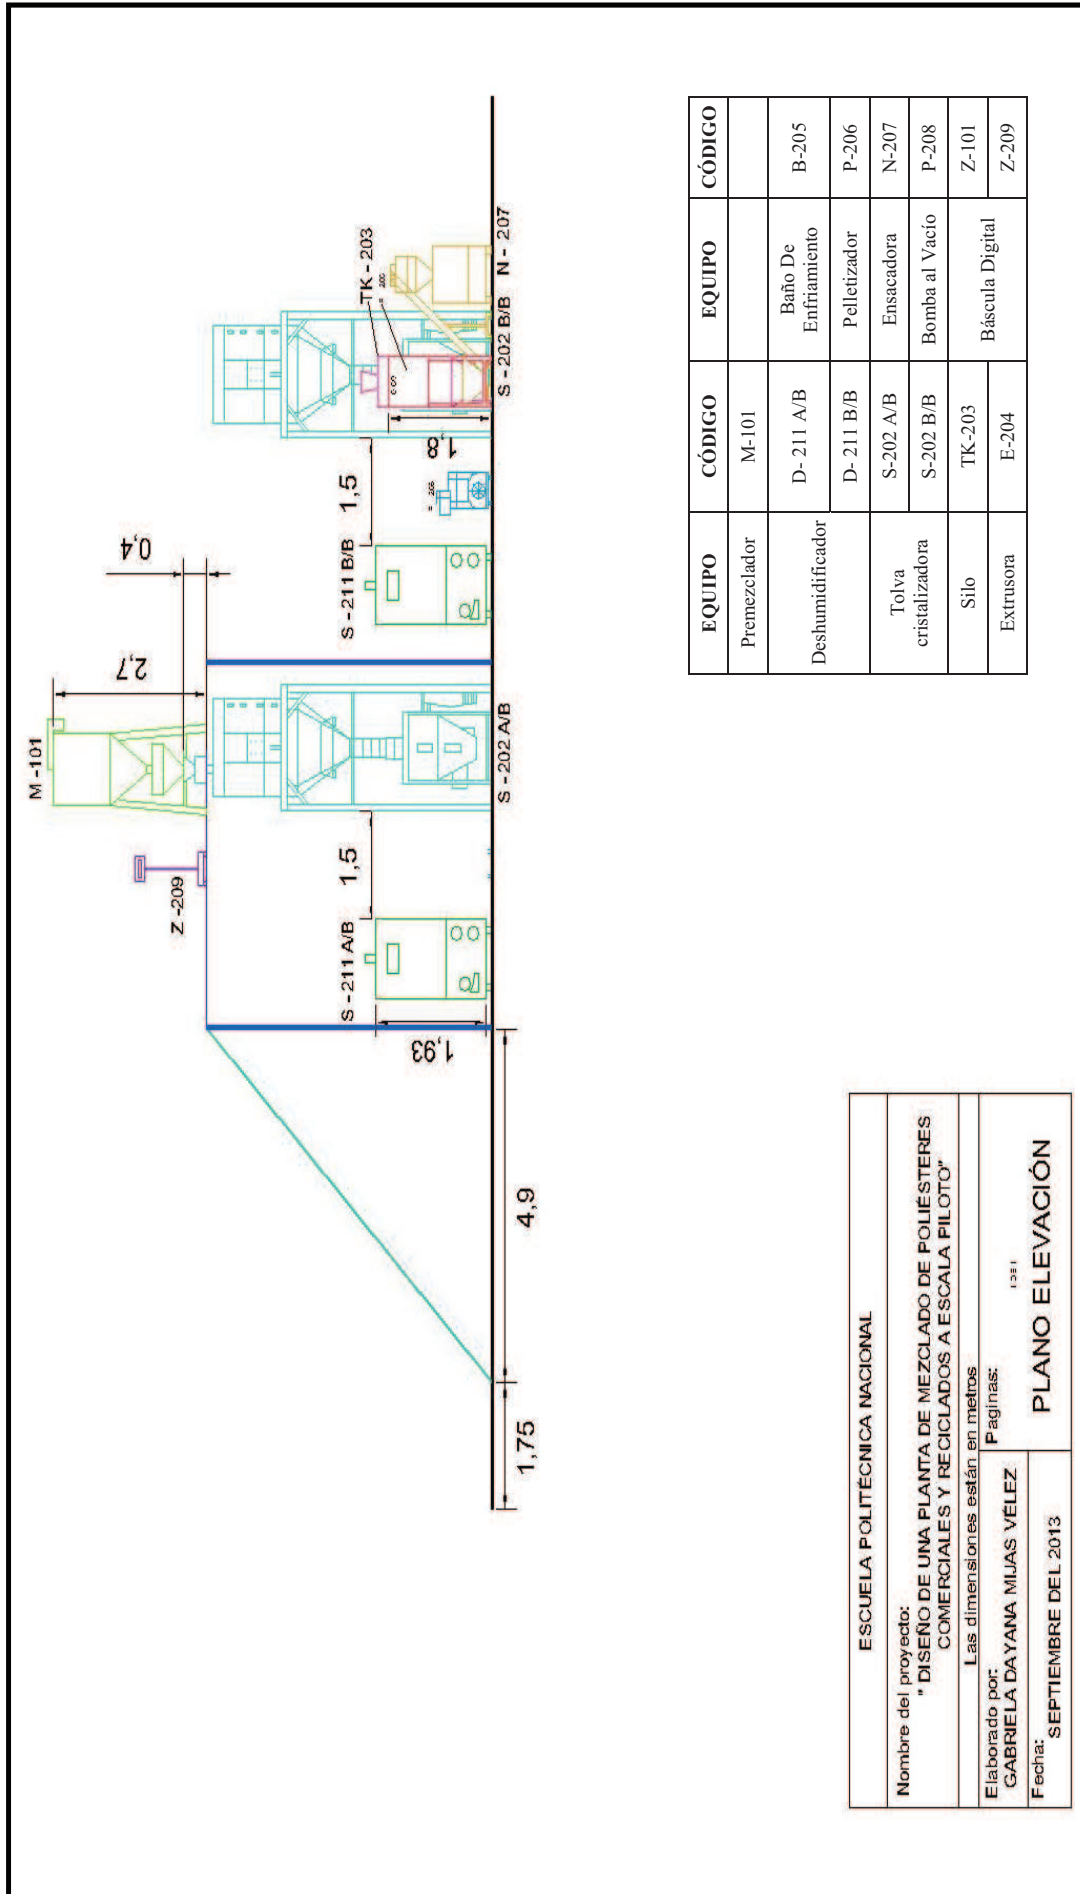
Plano de elevación de la planta piloto de mezclado de poliésteres comerciales y reciclados
